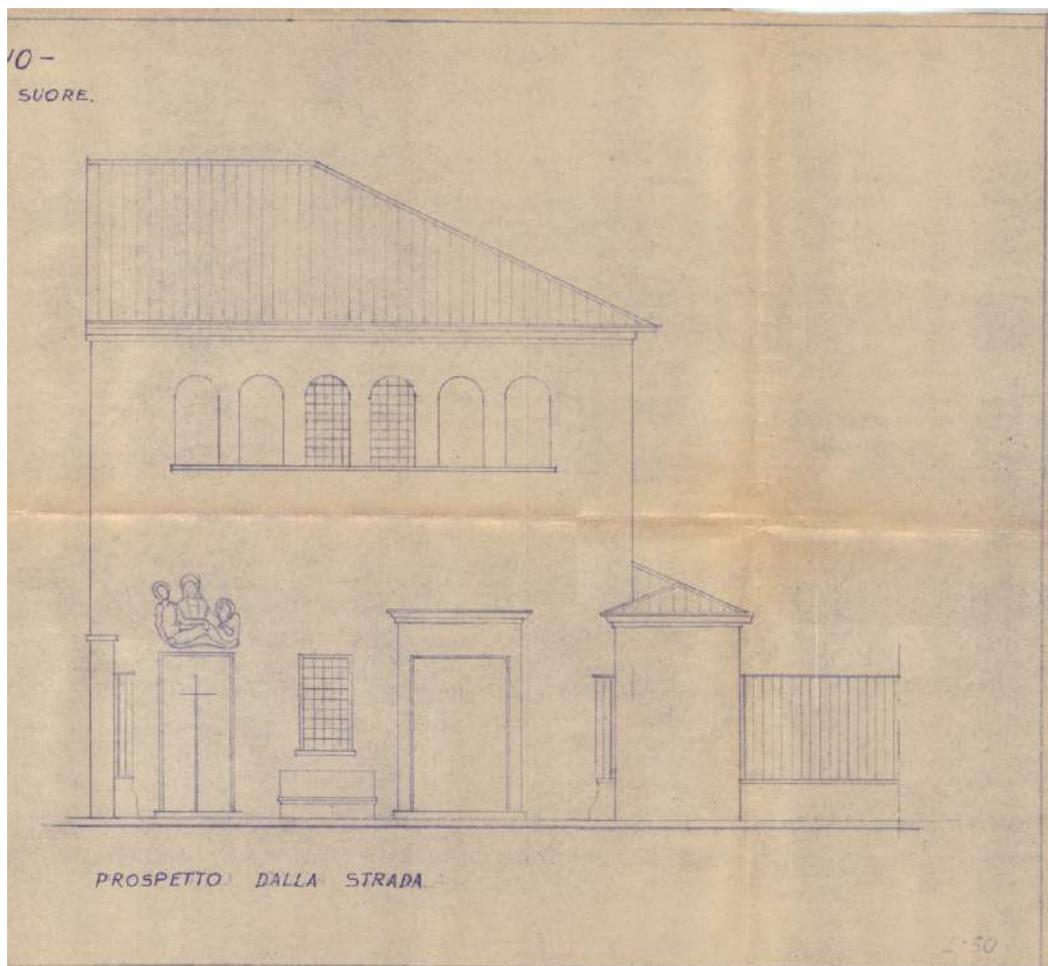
Prospetto su Via Boccaccio, pratica edilizia 129/1949, Archivio Comune di Seregno.
